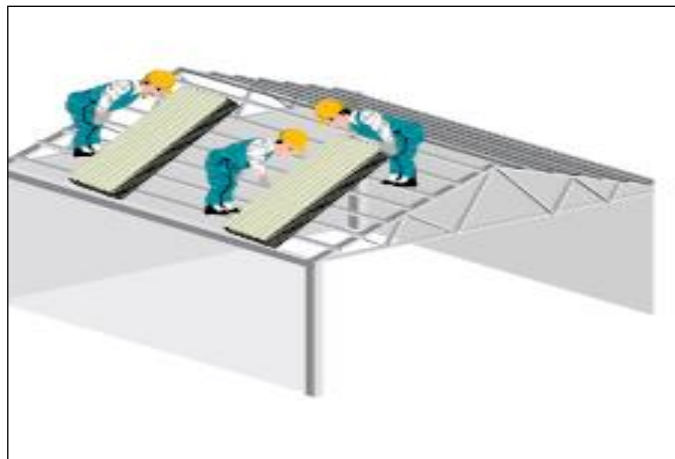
Almacenamiento de las tejas en grupos para su posterior instalación.
